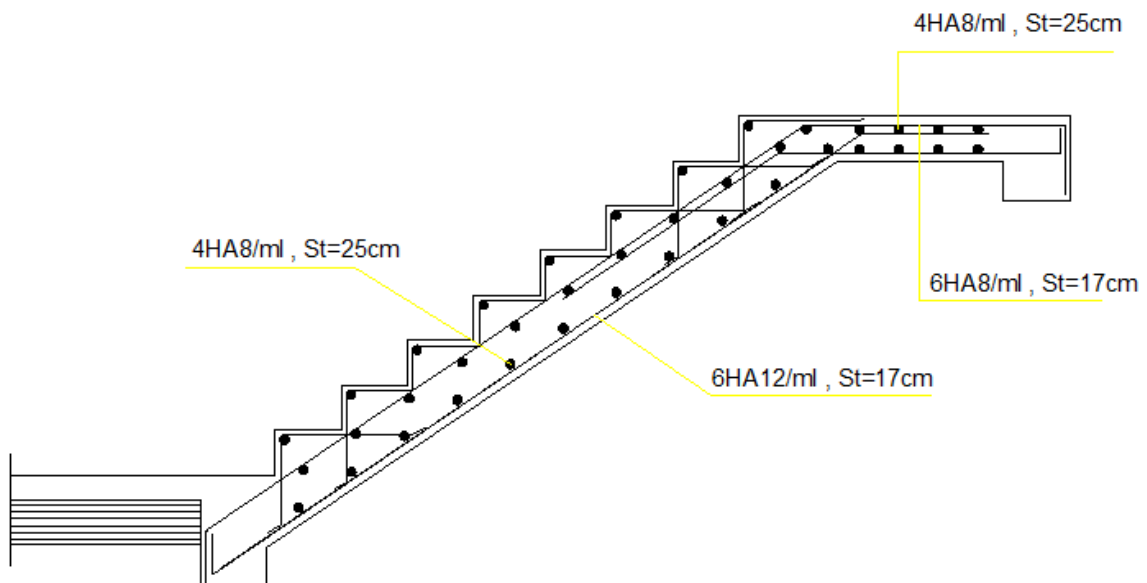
Schéma de ferrailage de l'escalier d'étage courant
